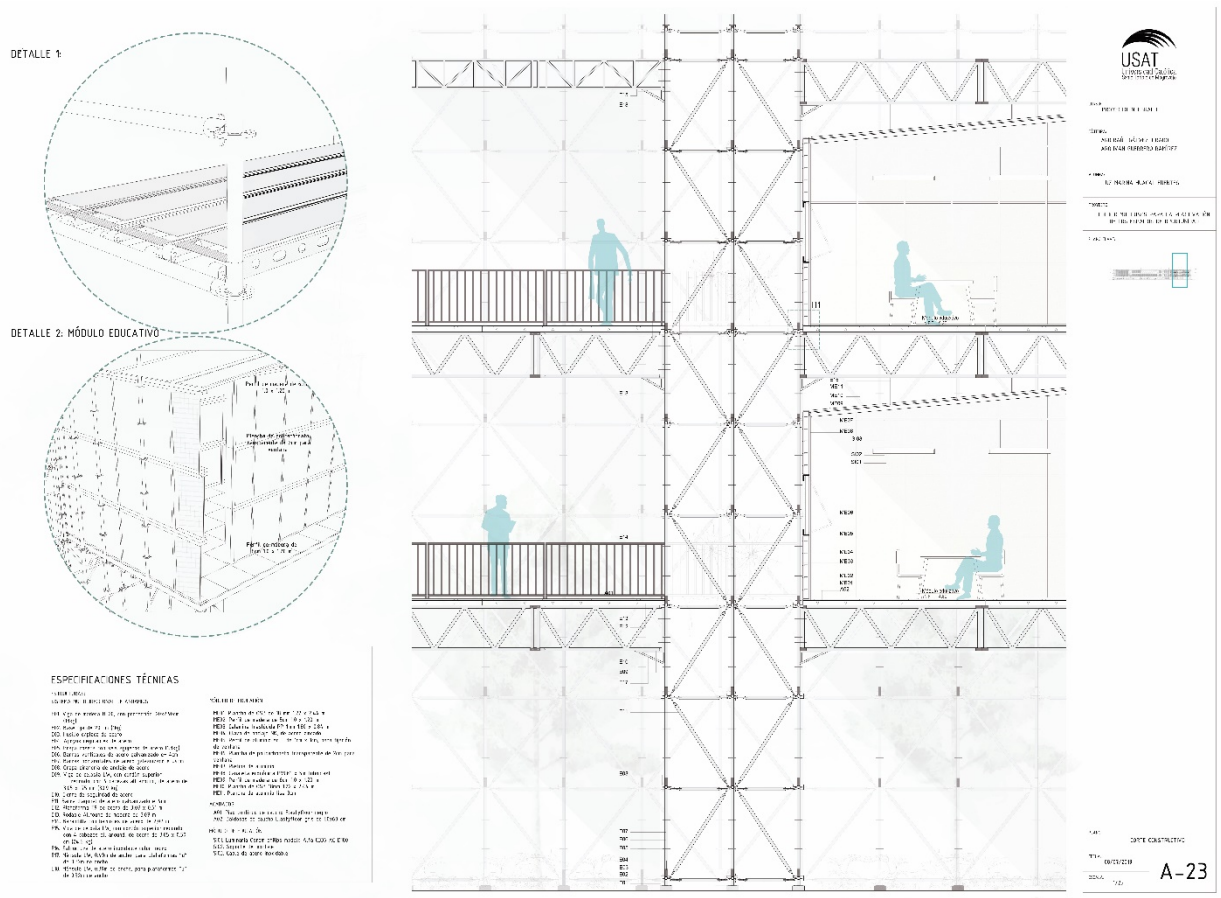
Corte constructivo. Fuente: Elaboración propia
